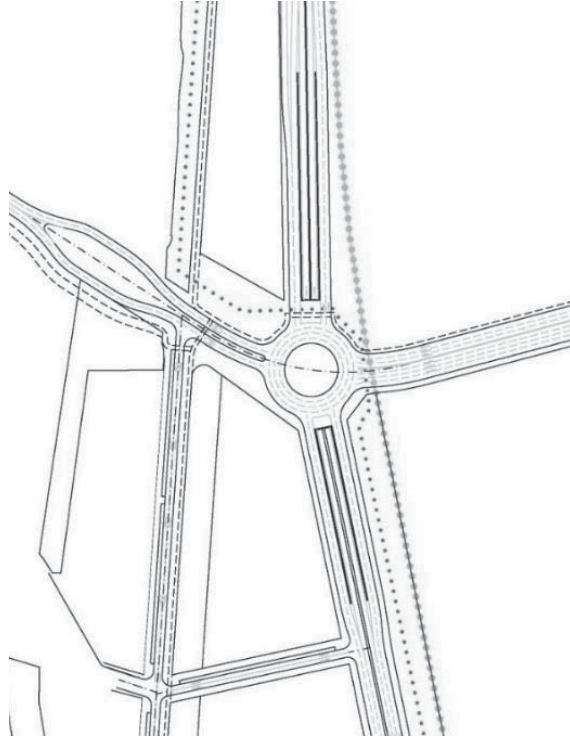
Planta del Paso inferior de Santo Domingo de la Calzada.
